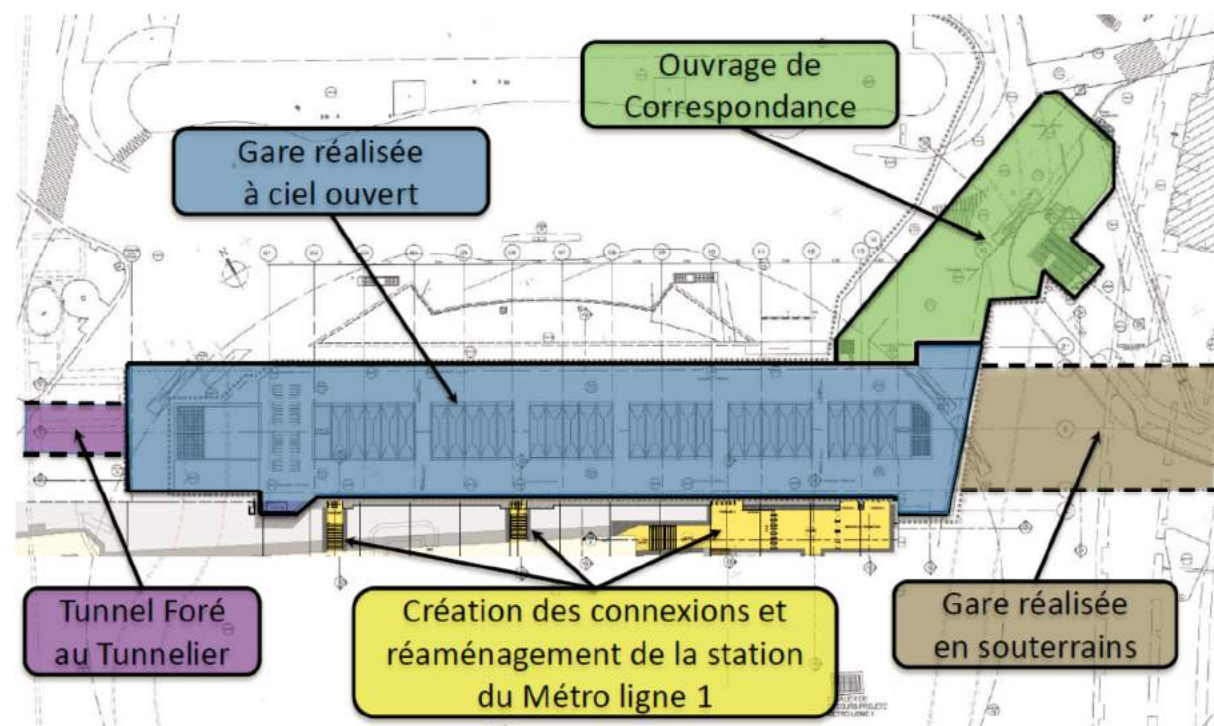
Schéma des principaux chantiers de construction de la gare Porte Maillot
